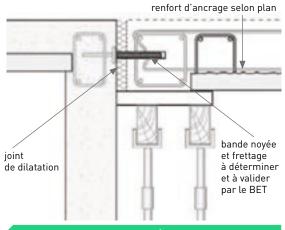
BANDE NOYÉE, FRETTAGE ET PRÉDALLE AVEC SUSPENTE
